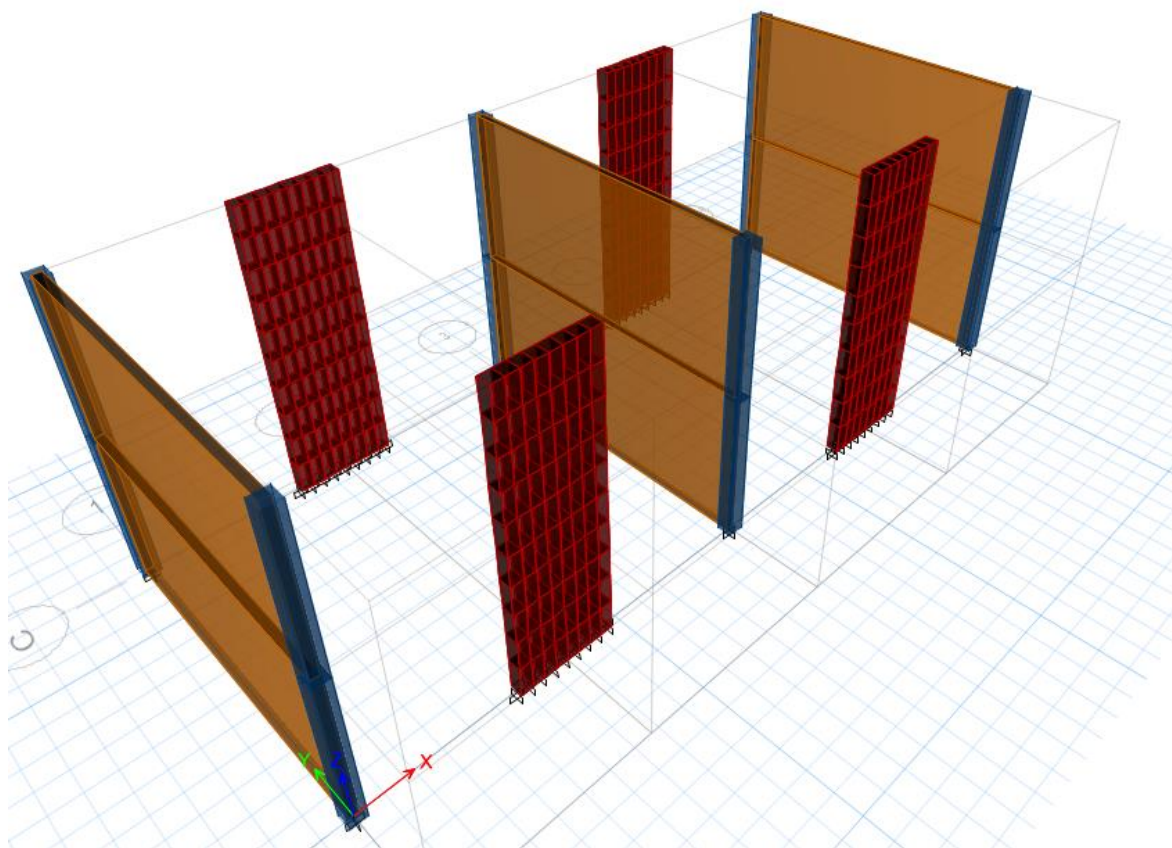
Vista en planta de los muros de corte en la dirección “X” del módulo 3.
